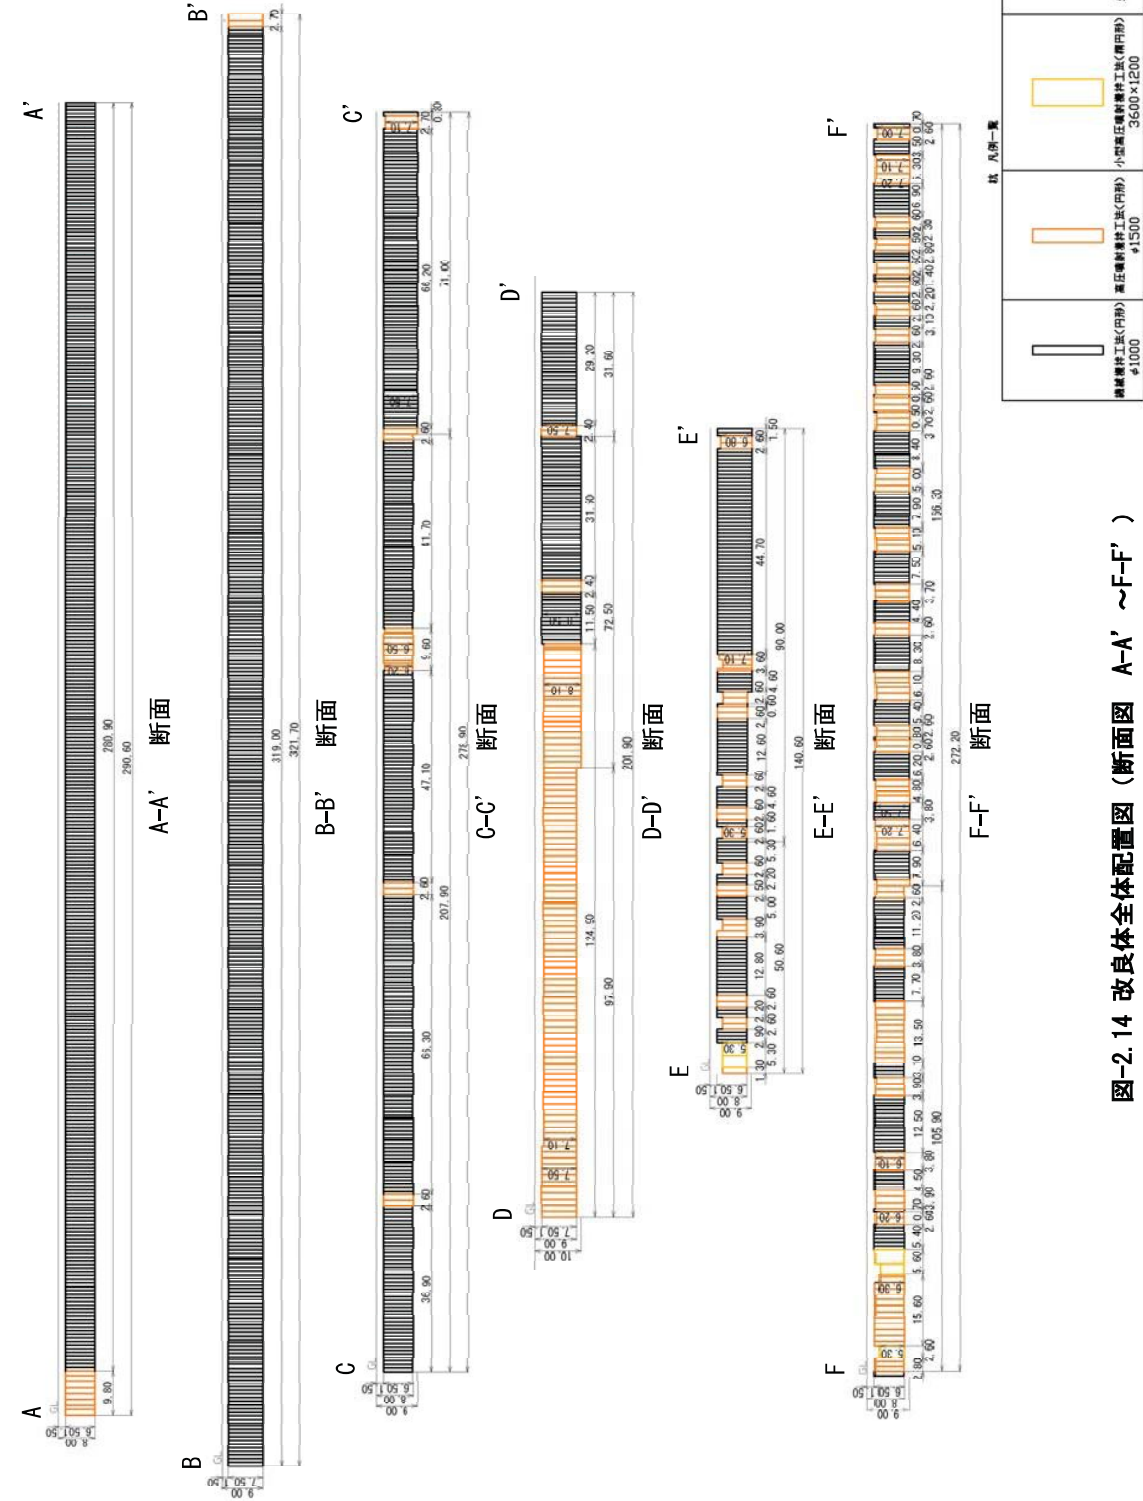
改良体全体配置図(断面図 A-A' ~ F-F')
